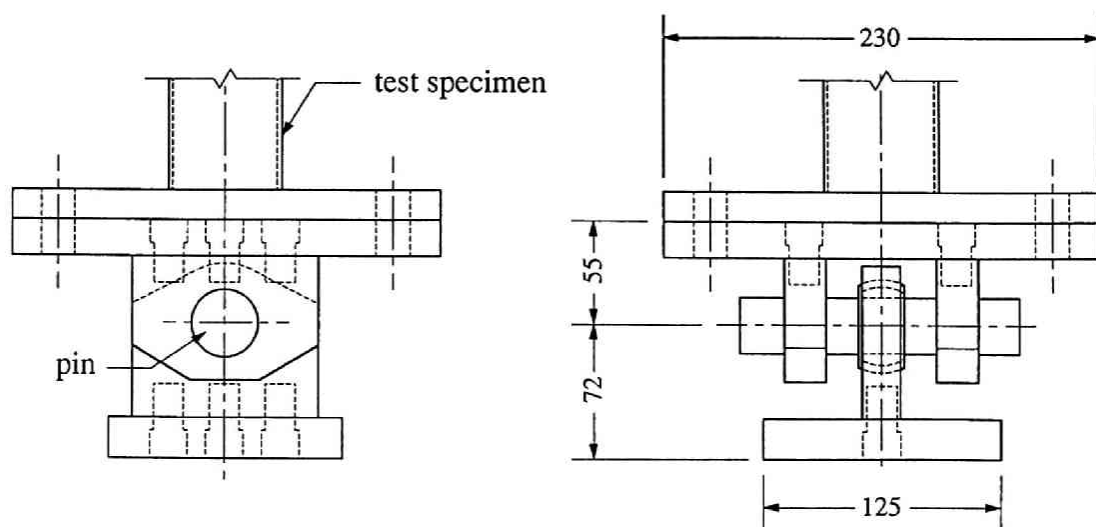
主柱材端部ピン支持部詳細 (単位 : mm)
